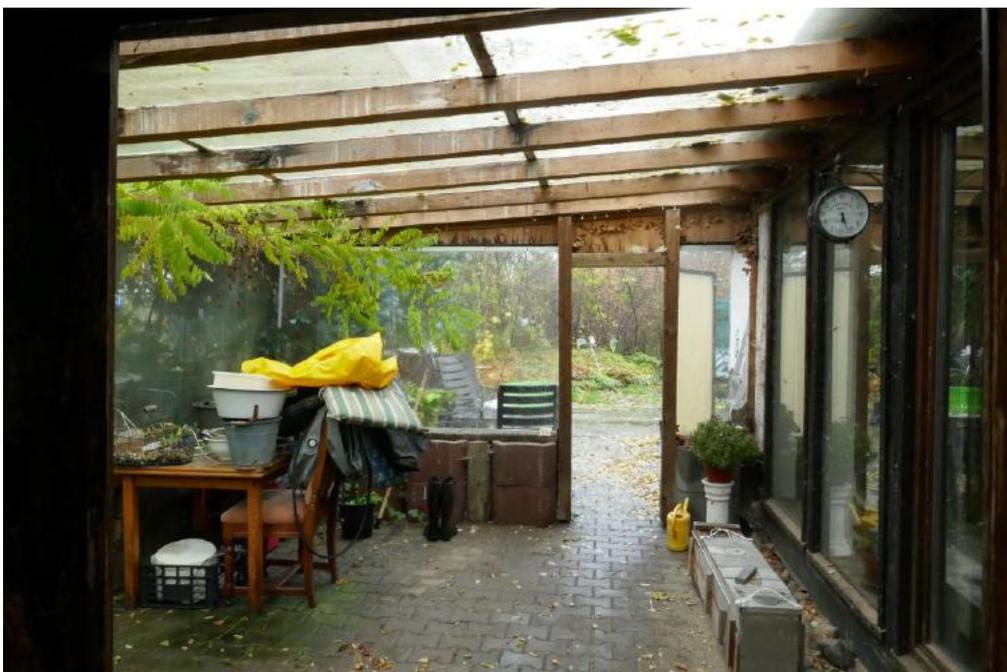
, Rückseite Wohn-/Einfamilienhaus (Geb. 1), überdachter und eingehauster Freisitz, Blick zur Zufahrt zum Nebengebäude, Garage (Geb. 3), Nordansicht
